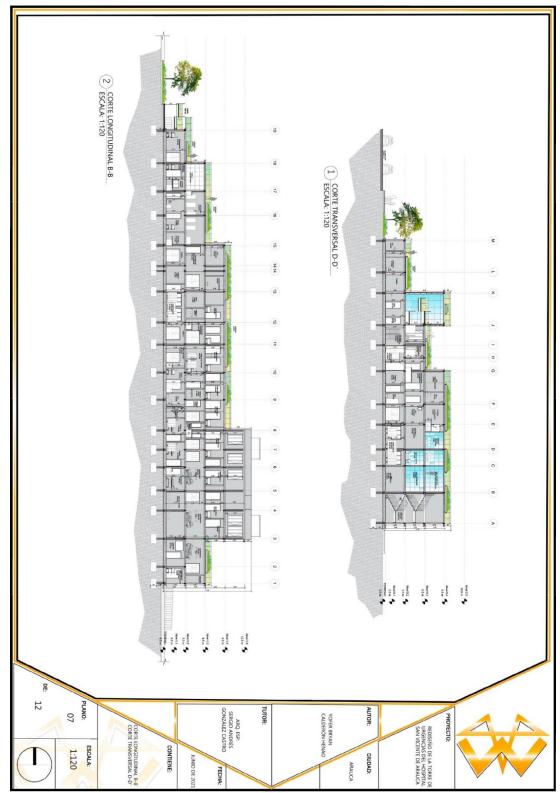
Cortes longitudinal B-B´y transversal D-D´. Fuente: elaboración propia
